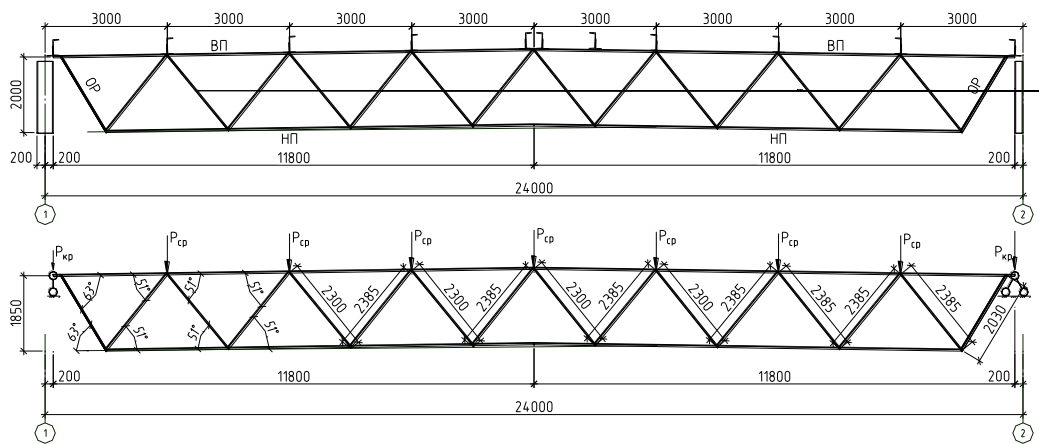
Конструктивная и расчетная схема фермы
